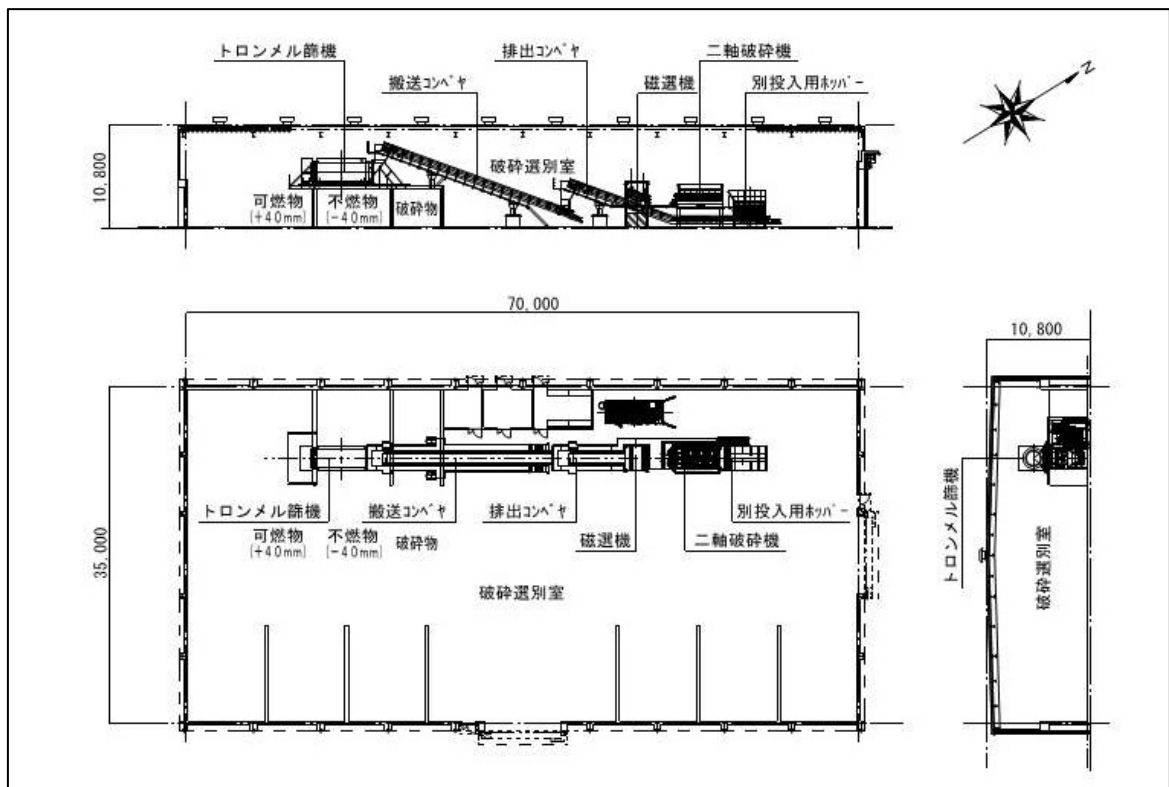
設備機器の平面図・断面図（リサイクル施設（選別破砕施設））
